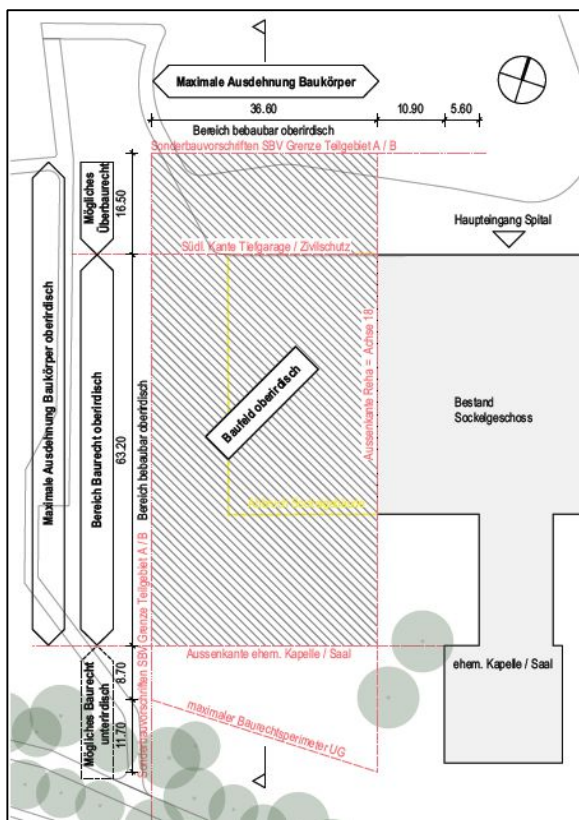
Grundrisschema Baufeld, Baurechtsperimeter
